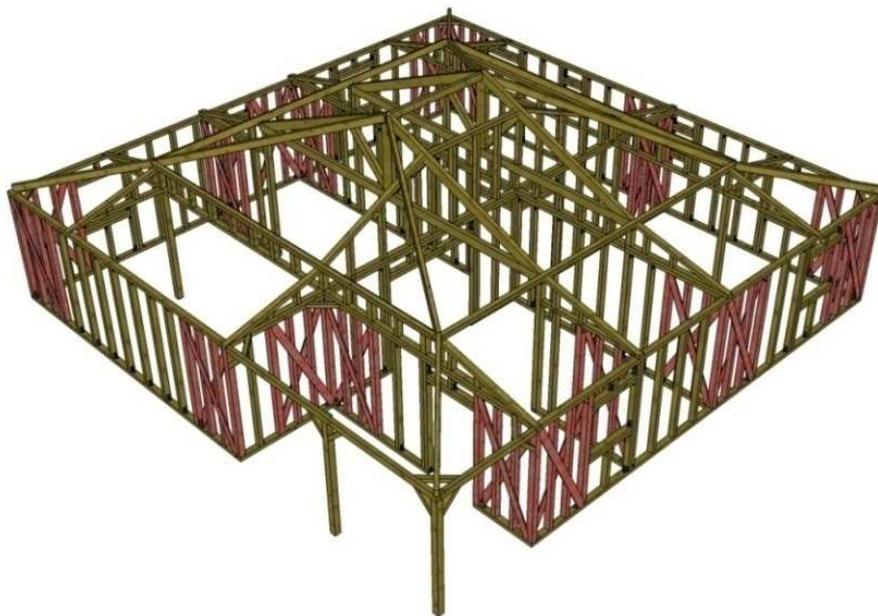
Exemple de maison à simple rez-de-chaussée avec toiture à rupture de pente.
